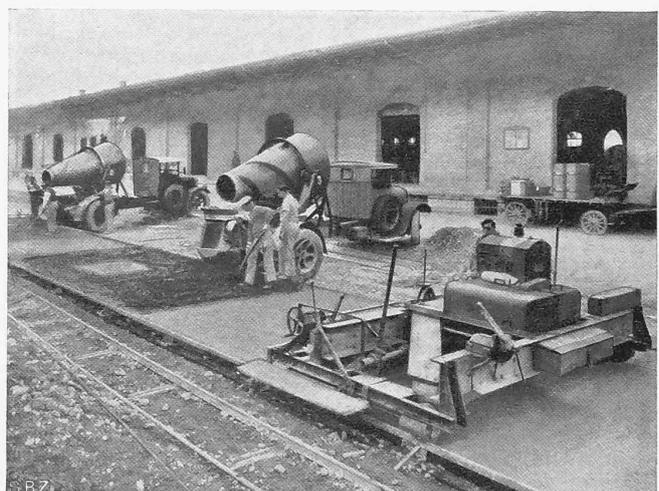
Bau einer Betonstrasse am Güterbahnhof Zürich.
